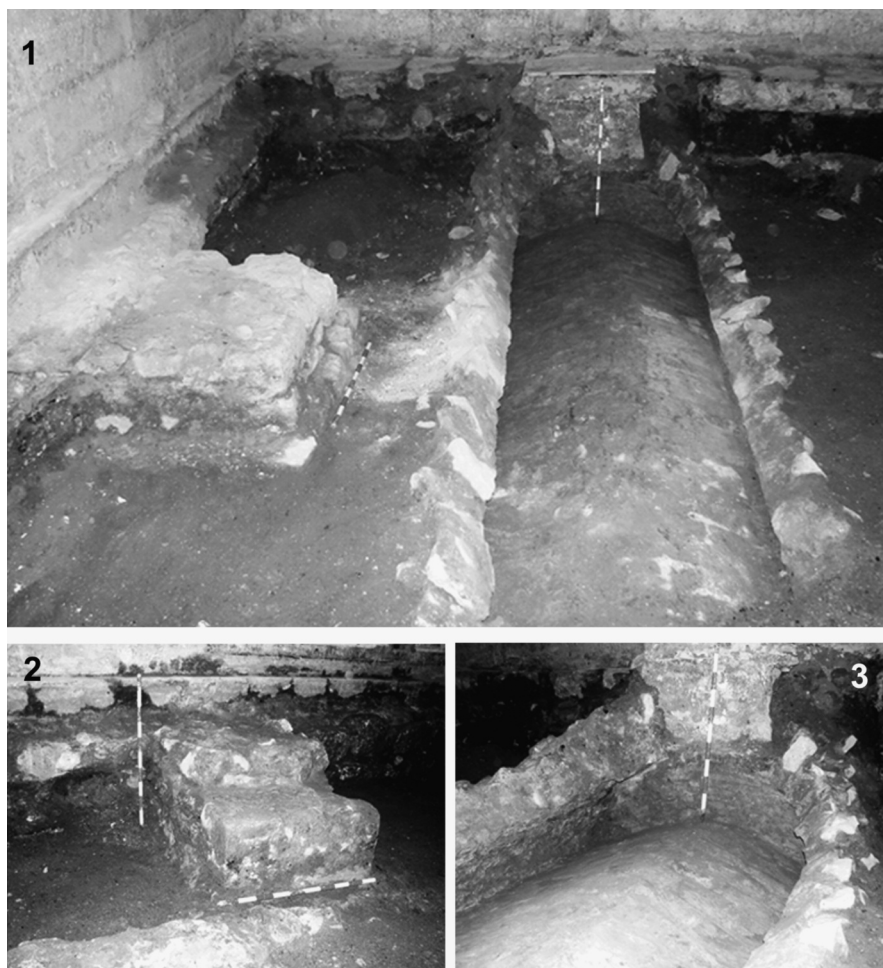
Área de intervención en la Sala D con la esgueva de Cerrajería y las estructuras de refuerzo de la plaza de Santa Águeda (estribos y muro)
